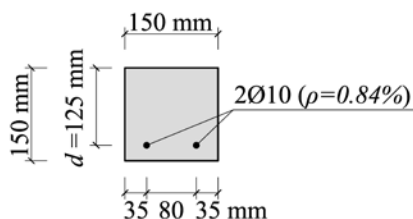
Detalle de la geometría y configuración de carga de las vigas de hormigón armado.
